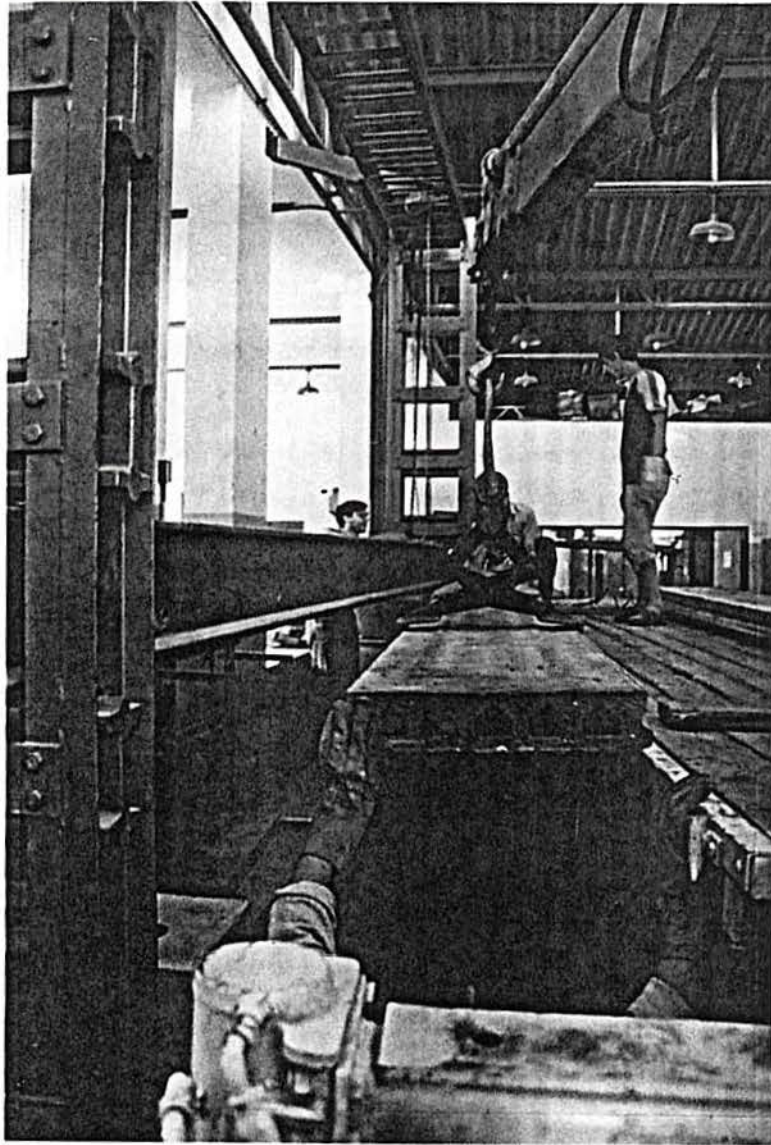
Vista da laje B1 sendo colocada no pórtico
